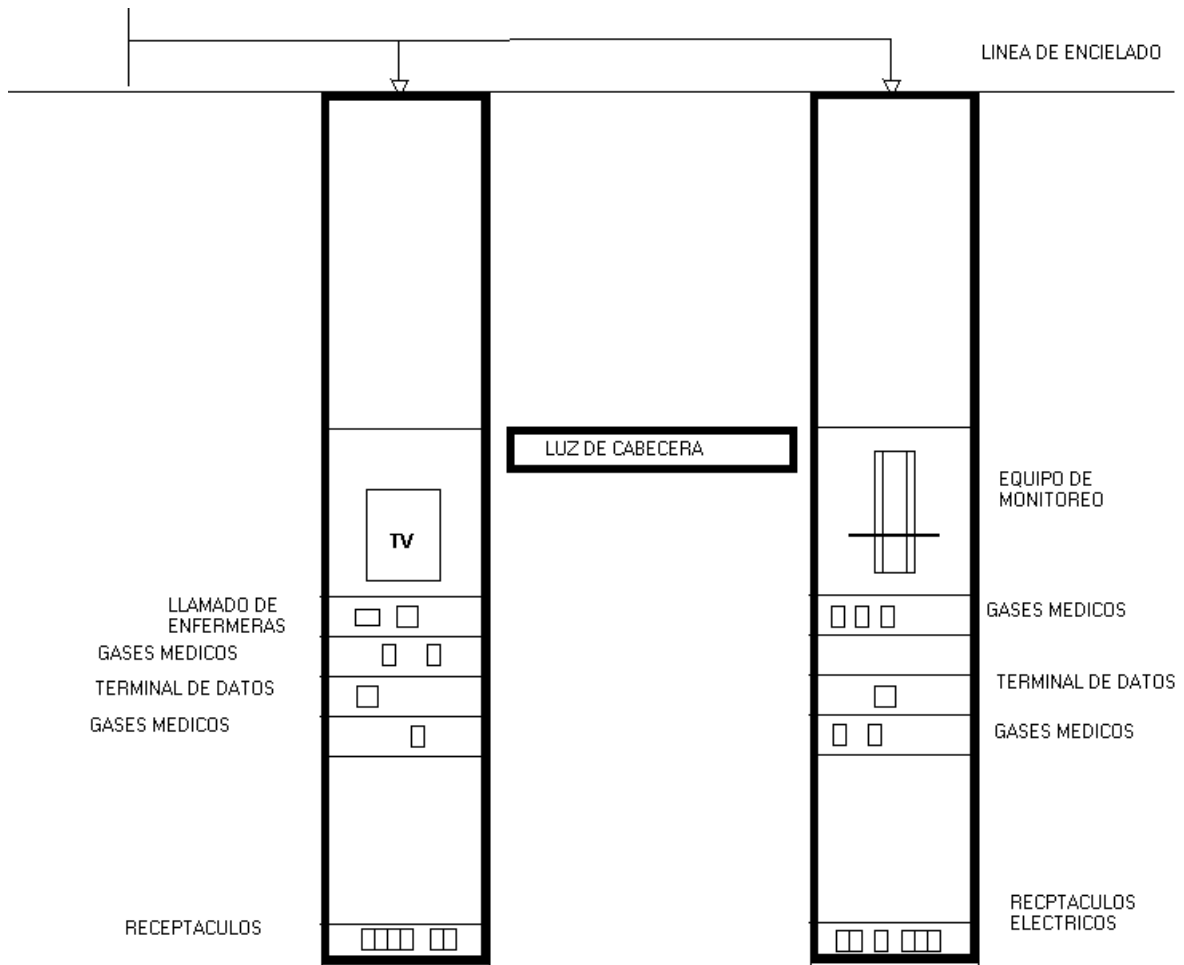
Ejemplo de columnas de servicio prefabricadas
